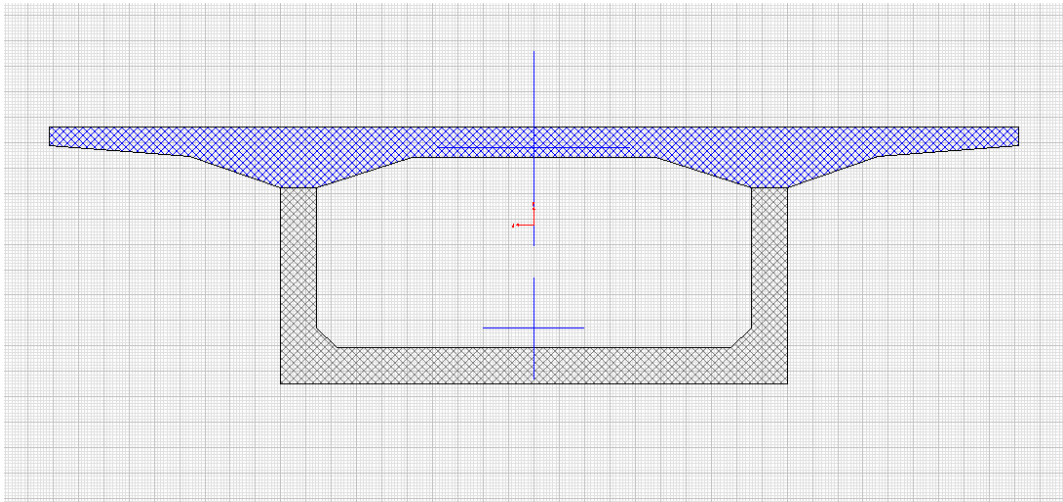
Dimensiones y propiedades de la viga cajón dovela 2A puente Bermúdez.
